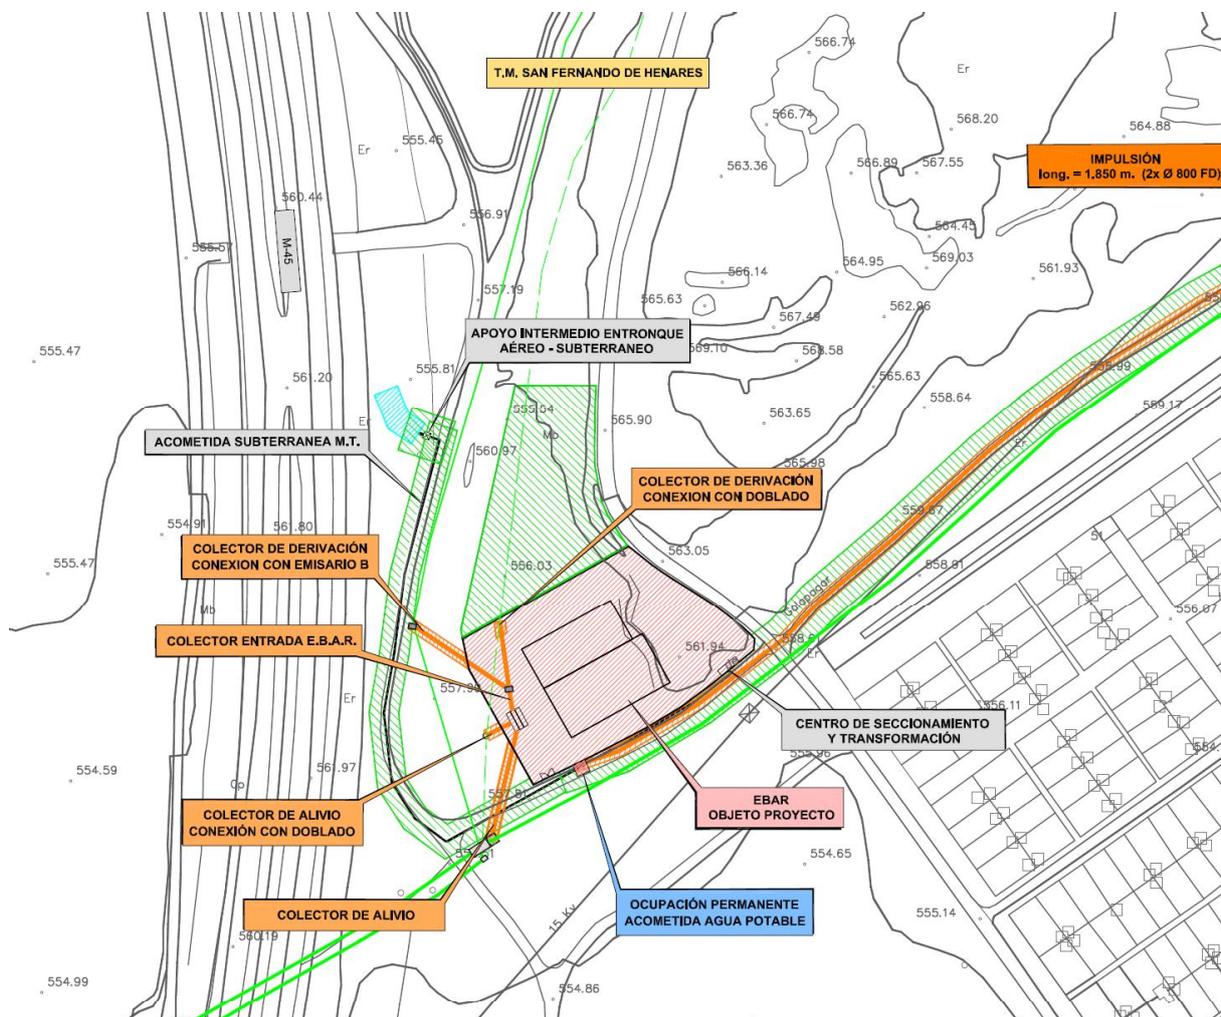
Alternativas de ubicación EBAR 3A
